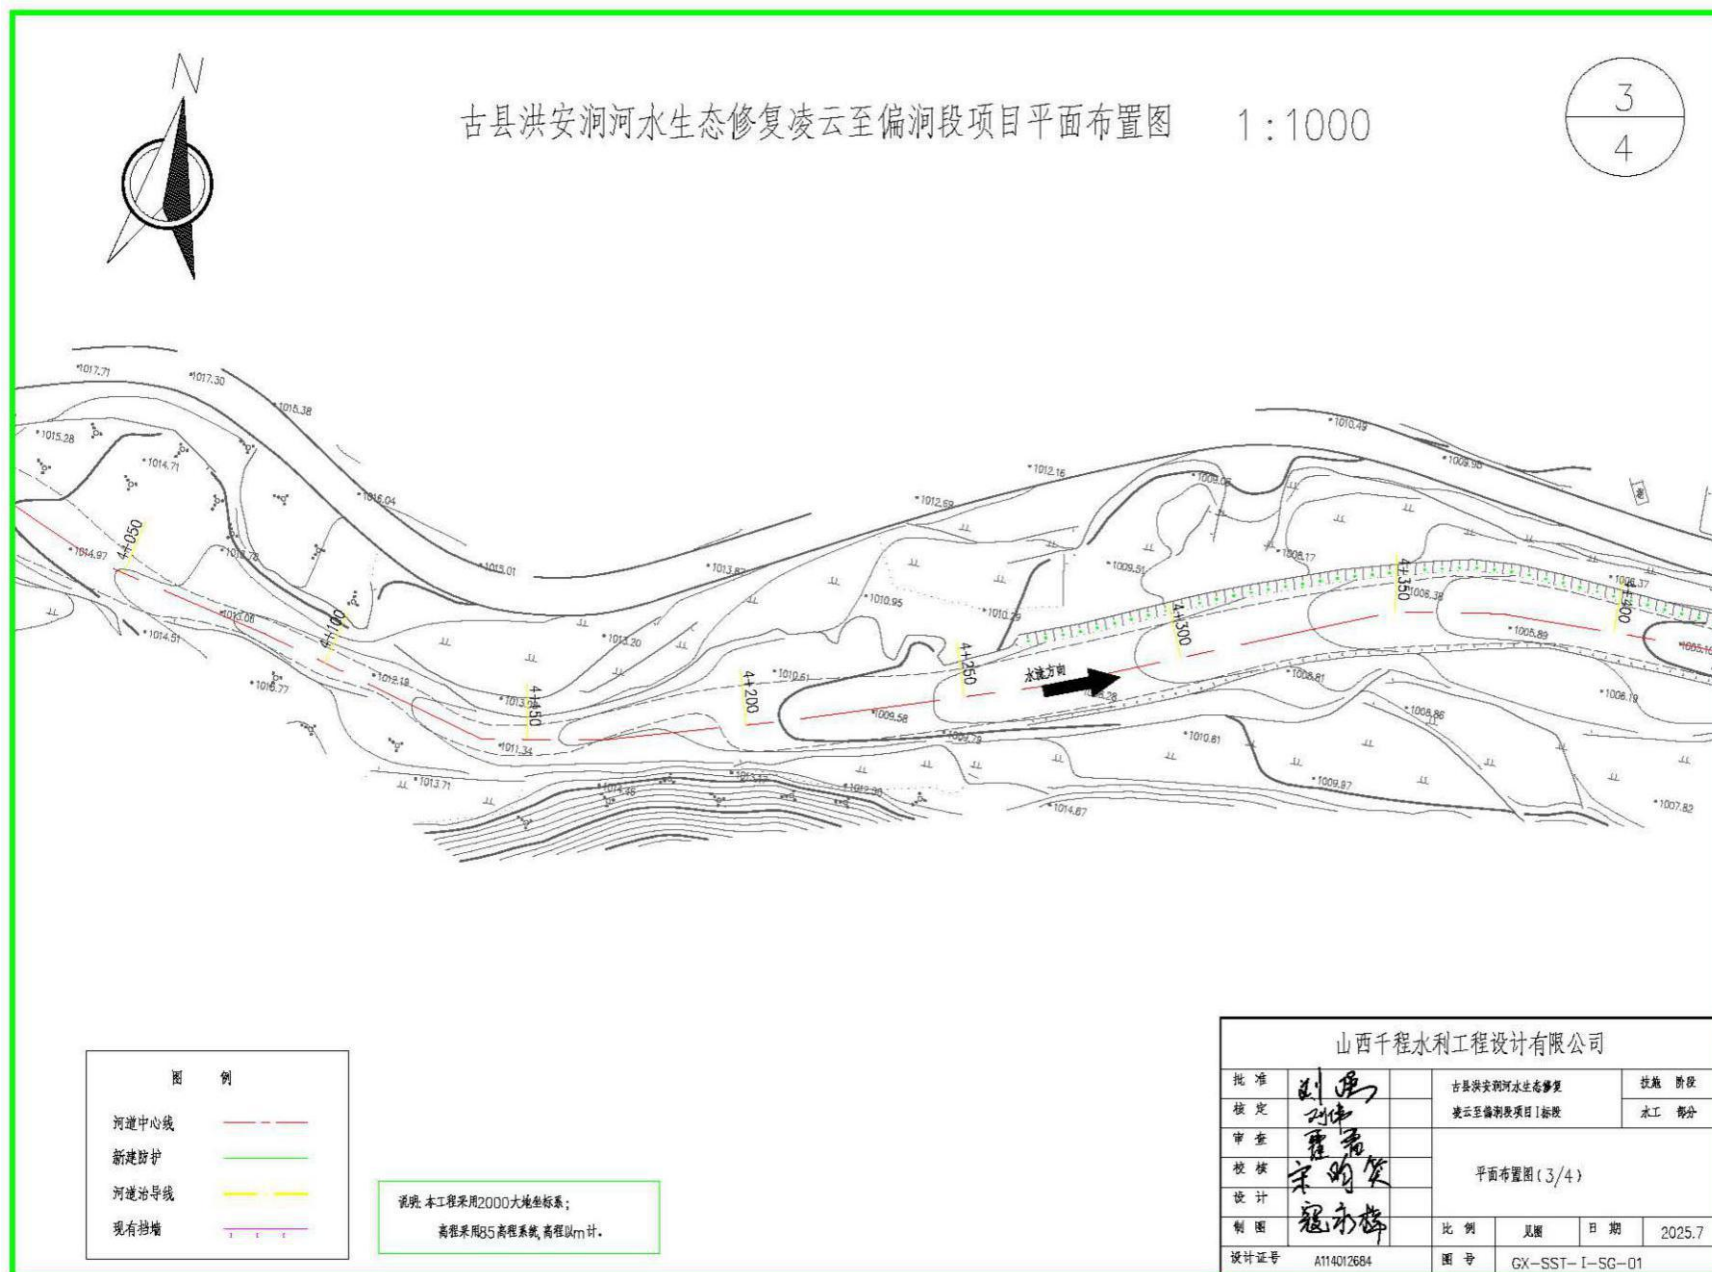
(3) 工程总平面布置图 (桩号 4+000-4+400)
